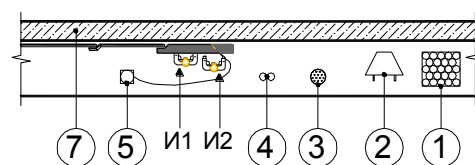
Схема организации рабочего места при устройстве вертикальной гидроизоляции
